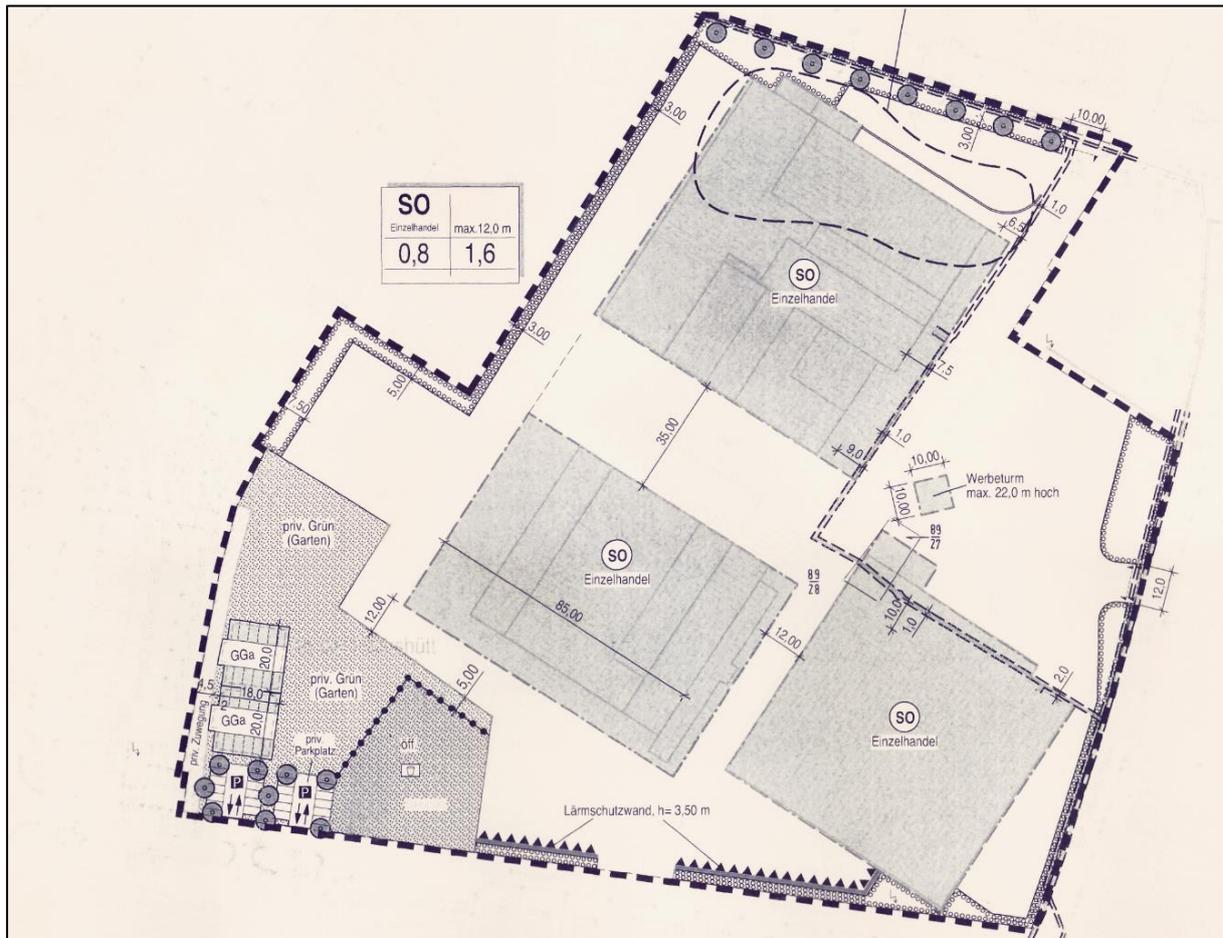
Ausschnitt Bebauungsplan »Hausener Straße«, Mayen
